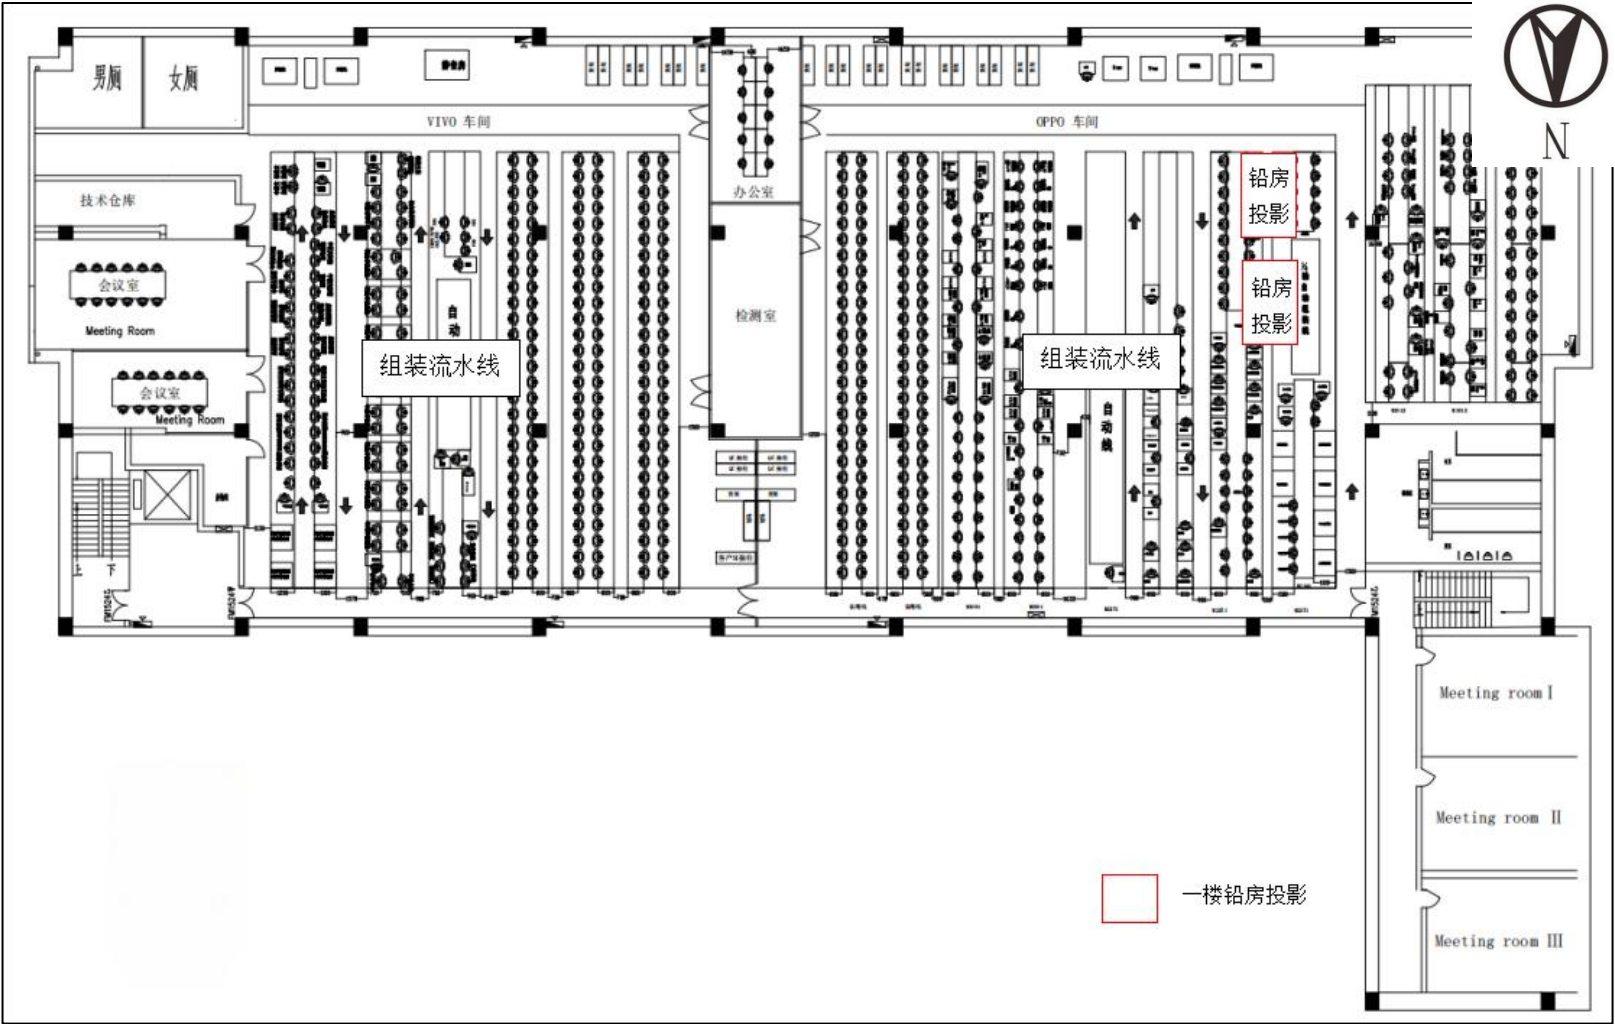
工业 CT 所在正上方楼层平面布置示意图
